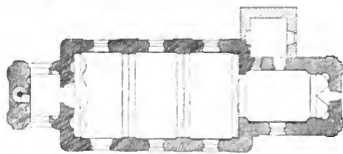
Alt-Knin. Grundriss der Kirche.
